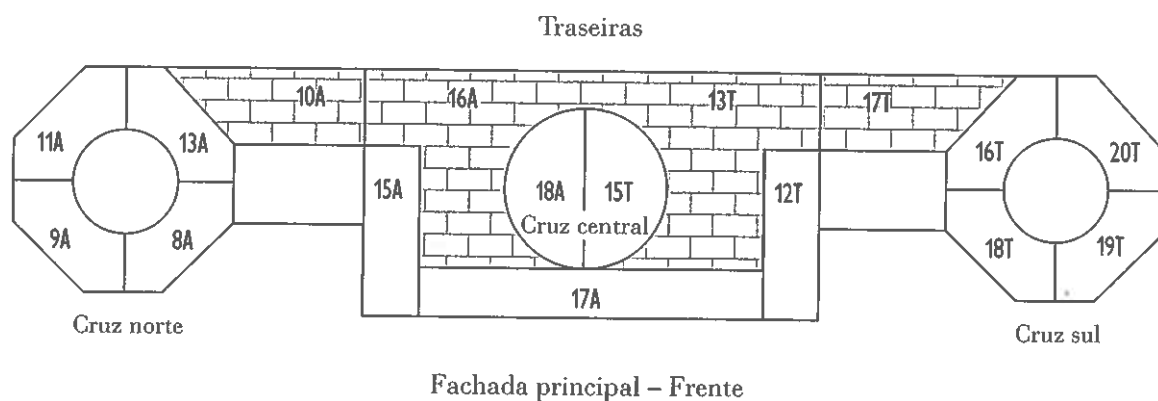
Fachada da Igreja de Santa Cruz. Vista do topo, assinalando os levantamentos levados a cabo nesta área.
